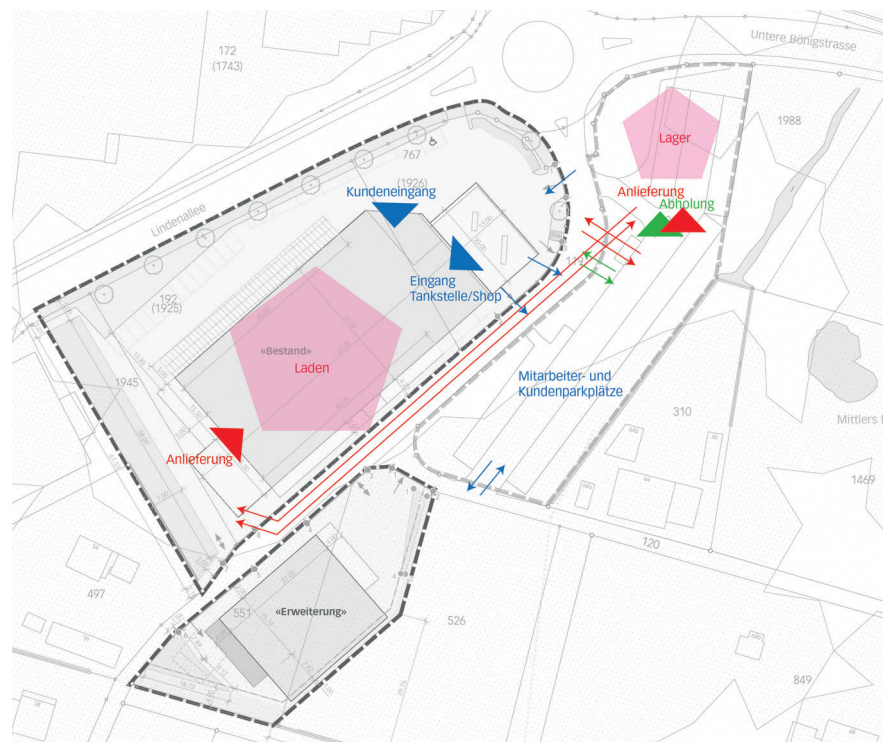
Erschliessungsschema mit Lagergebäude im nördlichen Teil der ZPP
